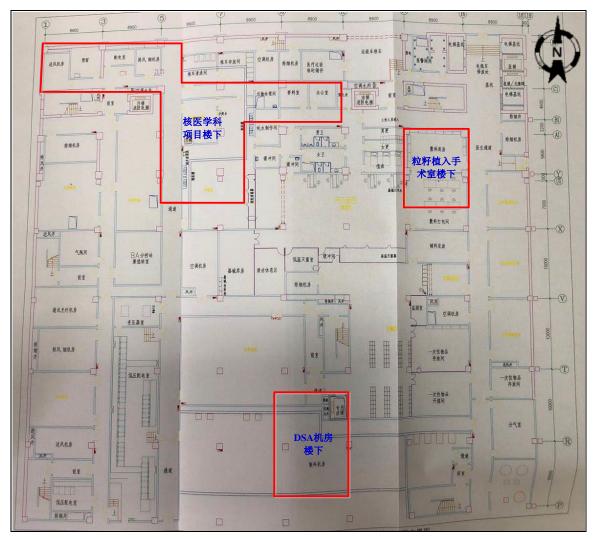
本次竣工环保验收项目楼下(住院楼负一楼)平面布置示意图
